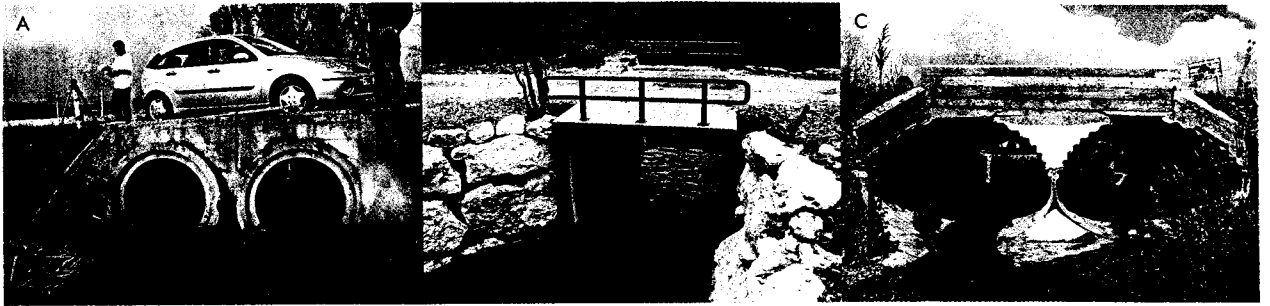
Los caños de drenaje pueden ser de múltiples formas y materiales. La figura muestra (a) un doble tubo de hormigón, (b) un caño caja de hormigón y (c) un doble caño elíptico de acero corrugado.
